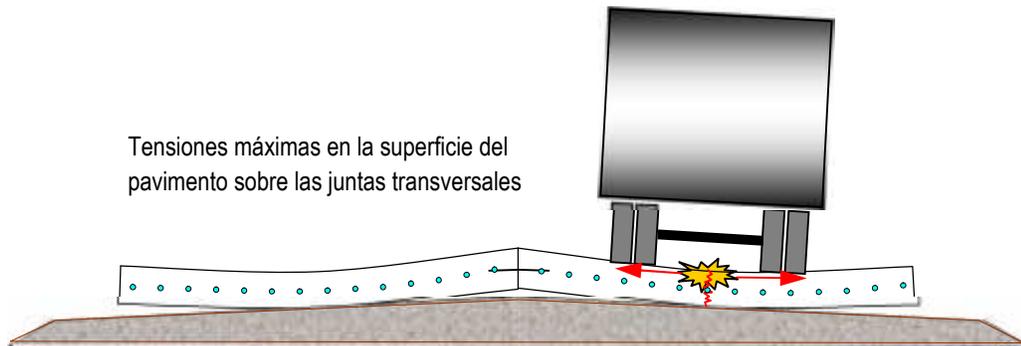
Esquema de la generación de fisuras longitudinales.
